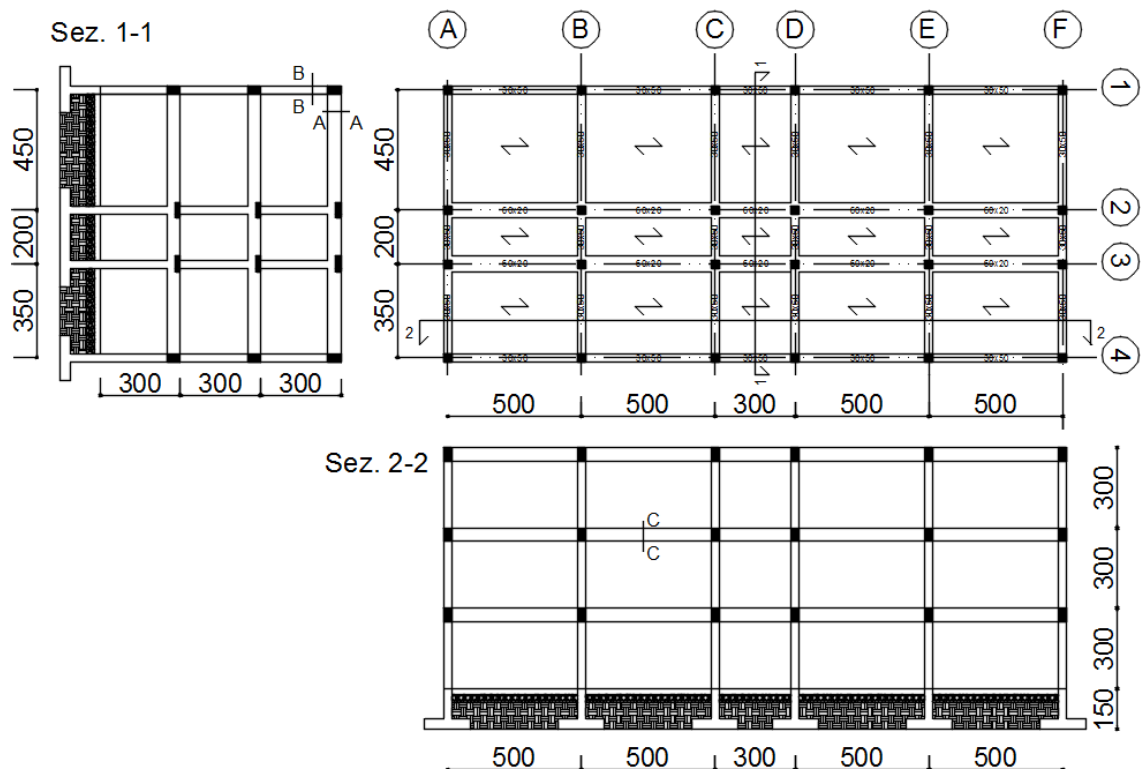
Struttura caso studio: Pianta del piano tipo e viste prospettiche telai principali.
